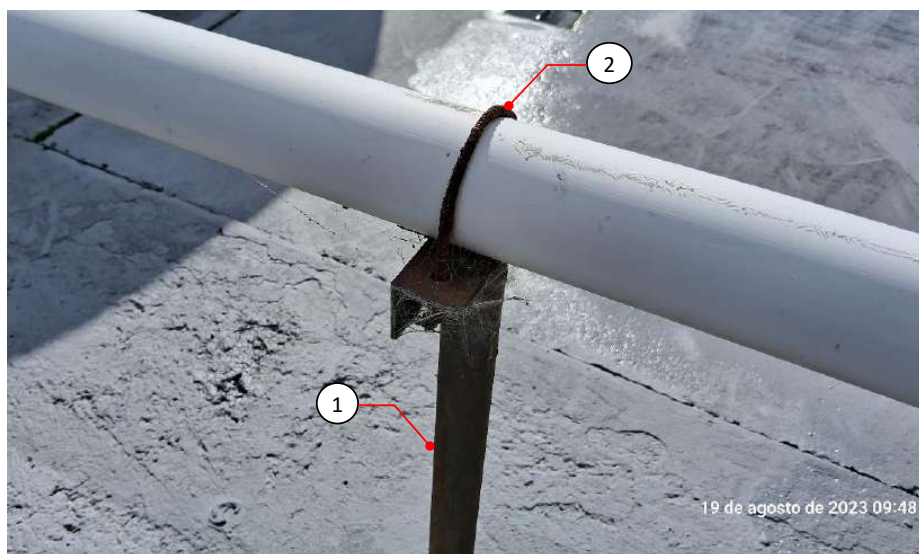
Vista da tubulação de coleta do biogás sobre a laje do reator UASB módulo 1: Suporte da tubulação (1); Abraçadeira metálica de perfil redondo (2).
